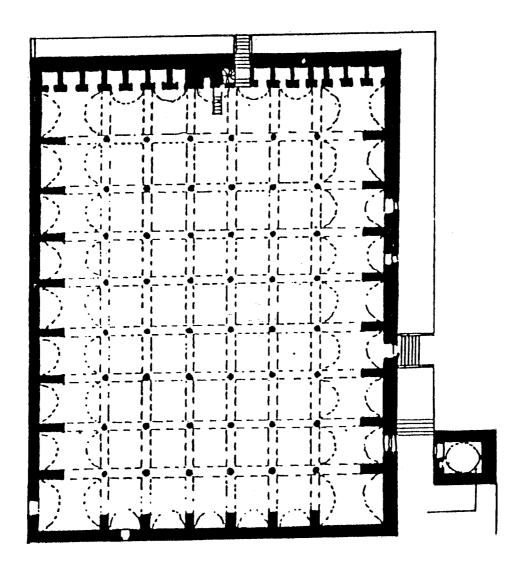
مسقط أفقي لمسجد محمد بن خيرون المعافري المعروف بمسجد الأبواب الثلاثة بالقيروان بتونس . (عن : Creswell).
